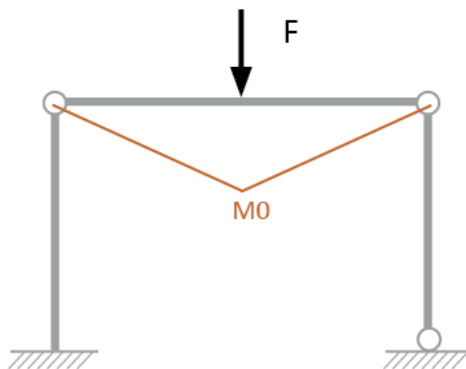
Schéma du moment pour un assemblage poutre-poteau articulé
